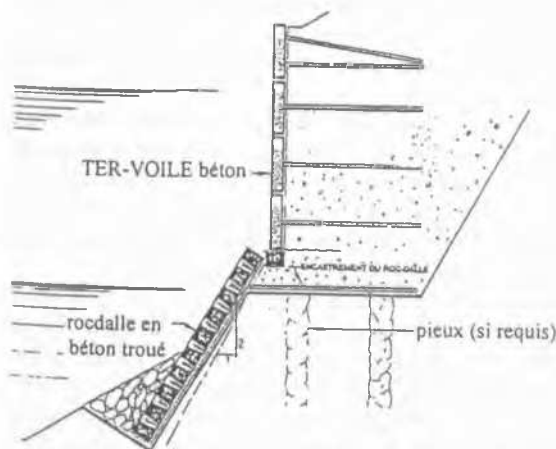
Rocdalle béton troué/TER-VOILE PLEIN-Coupe type
